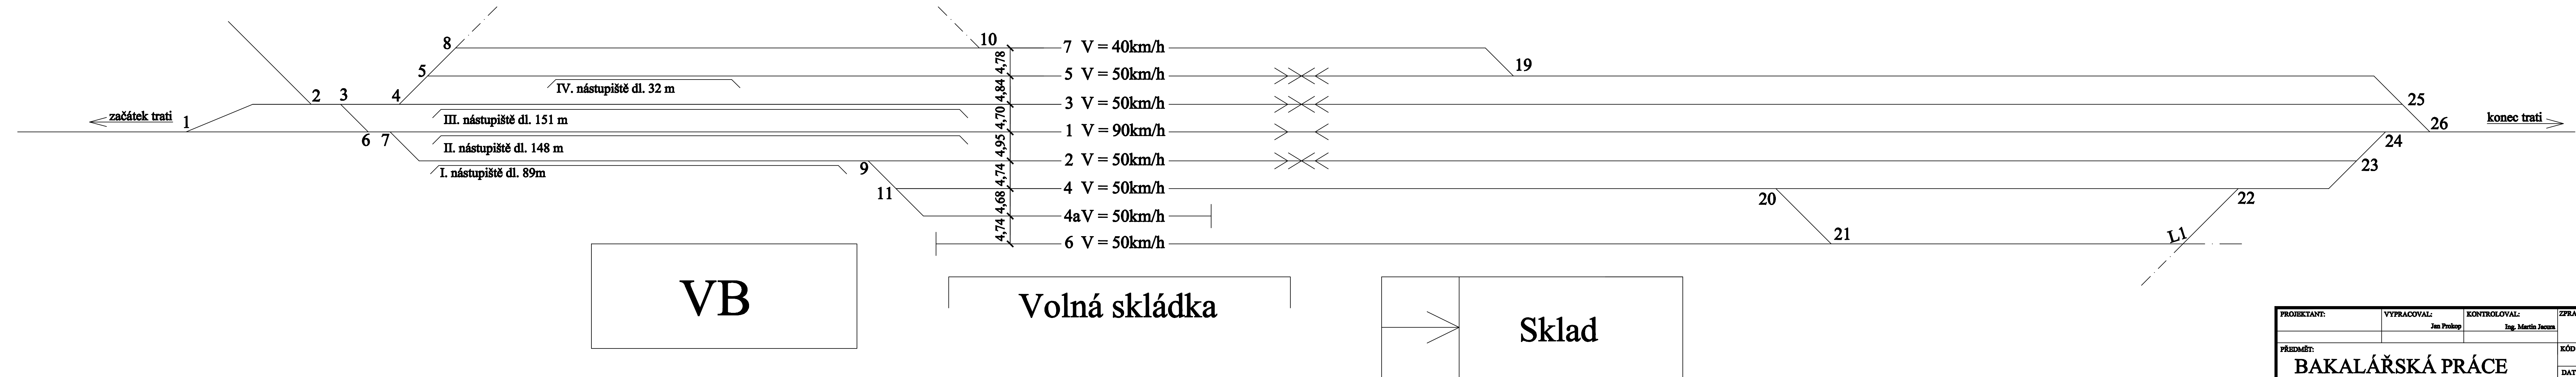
Všechny výhybky jsou ovládány elektromotorem
